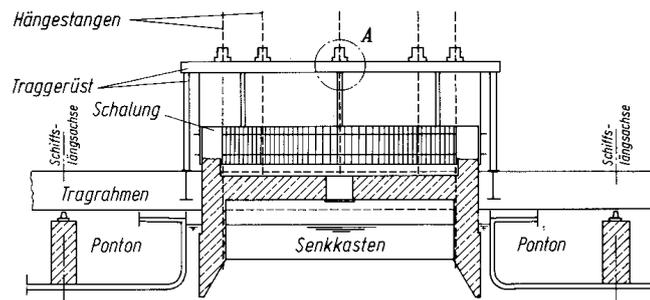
Absenkvorrichtung mit Senkkasten auf einer gekoppelten Einschwimmpontoneinheit [2]
